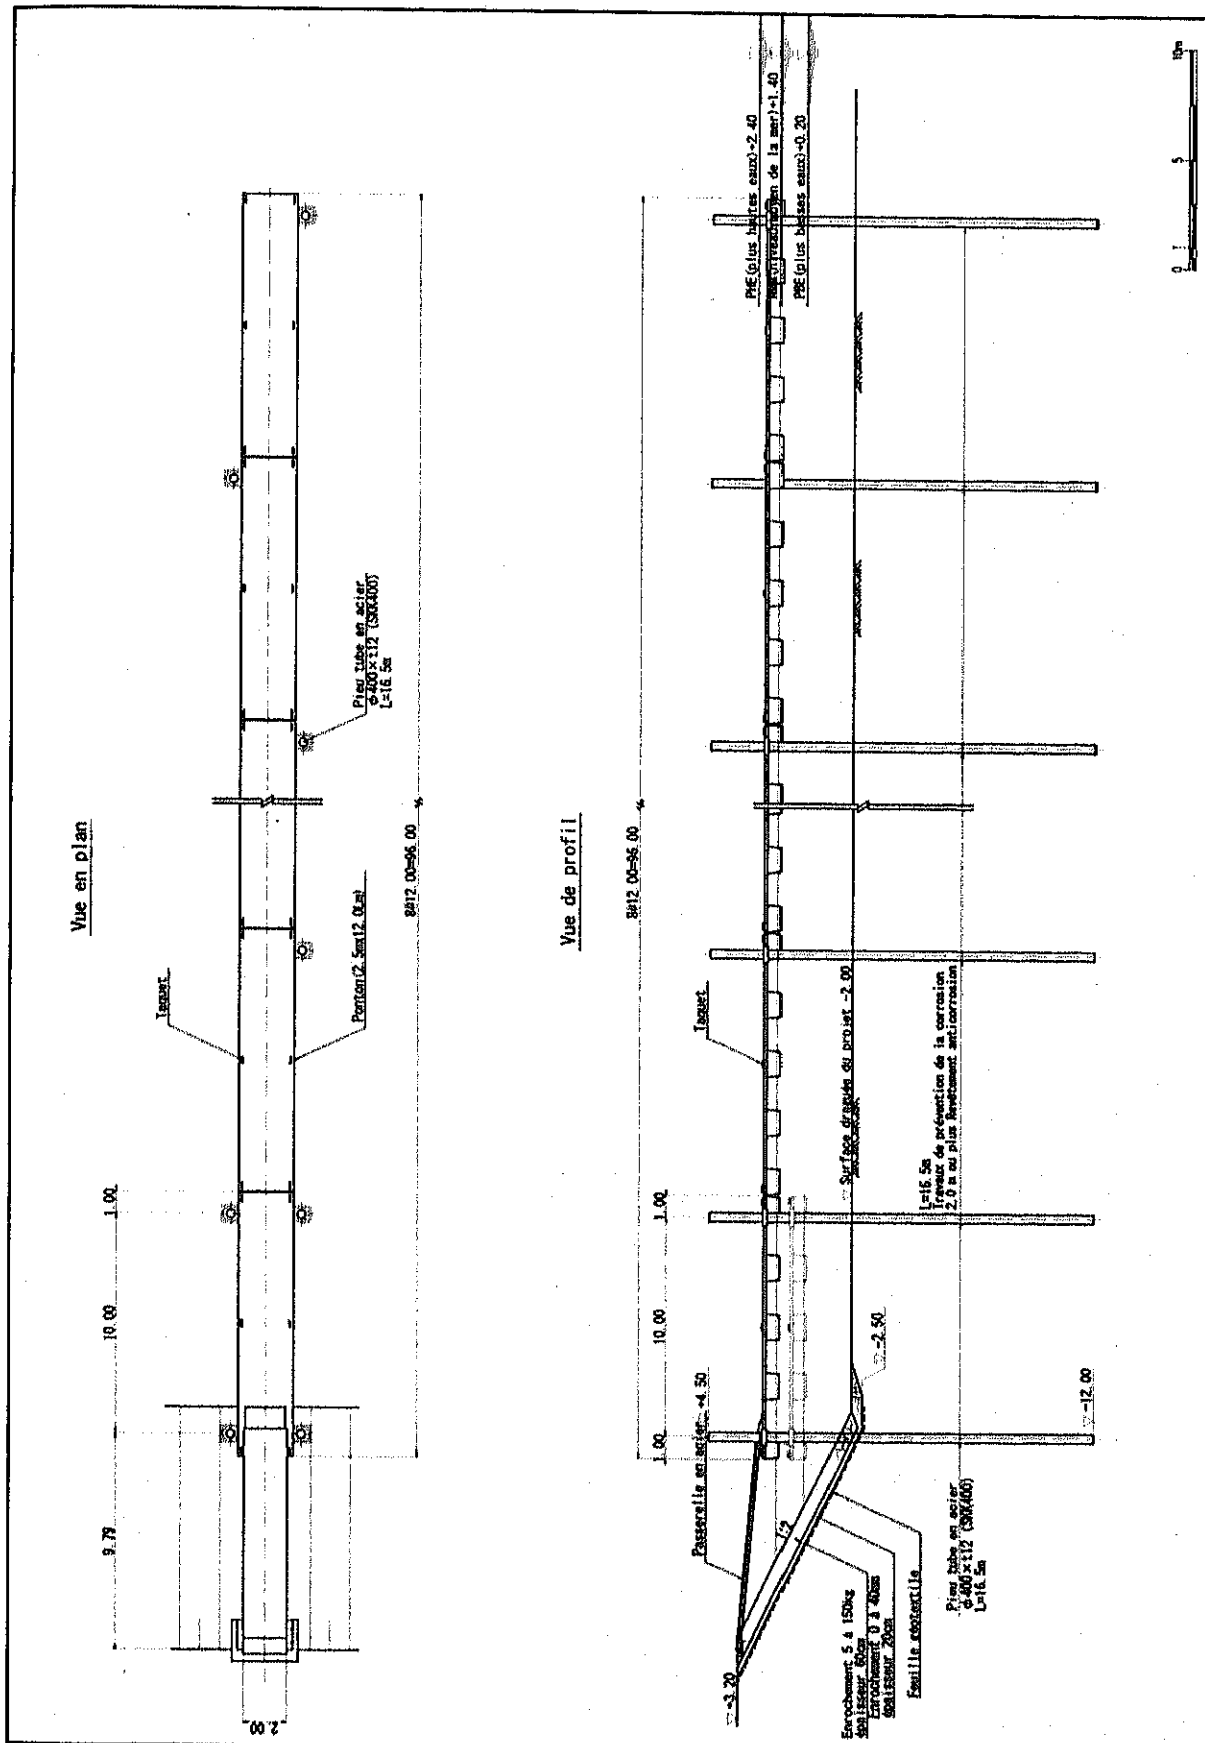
(3) Plan structurel des pontons d'amarrage
